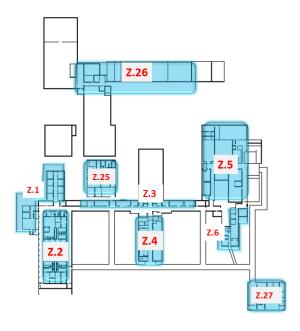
Ubicación de las Zonas (1-6 y 25-28) en Planta Baja Fuente: Autores
